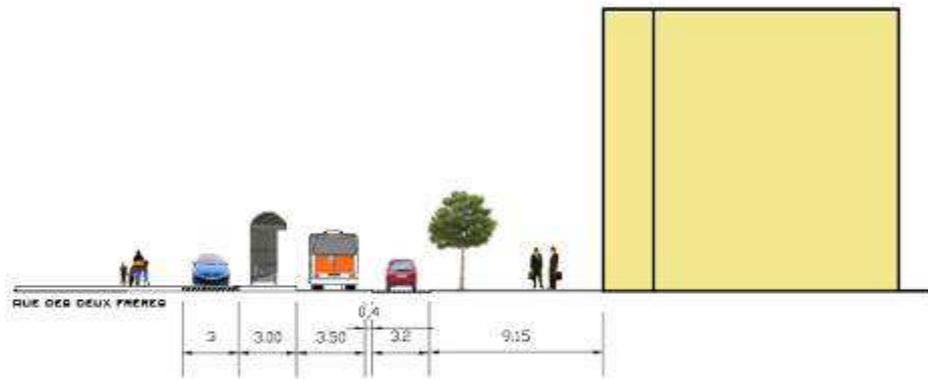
Plan en coupe de la station « Les 2 Frères » vers la place Simart
